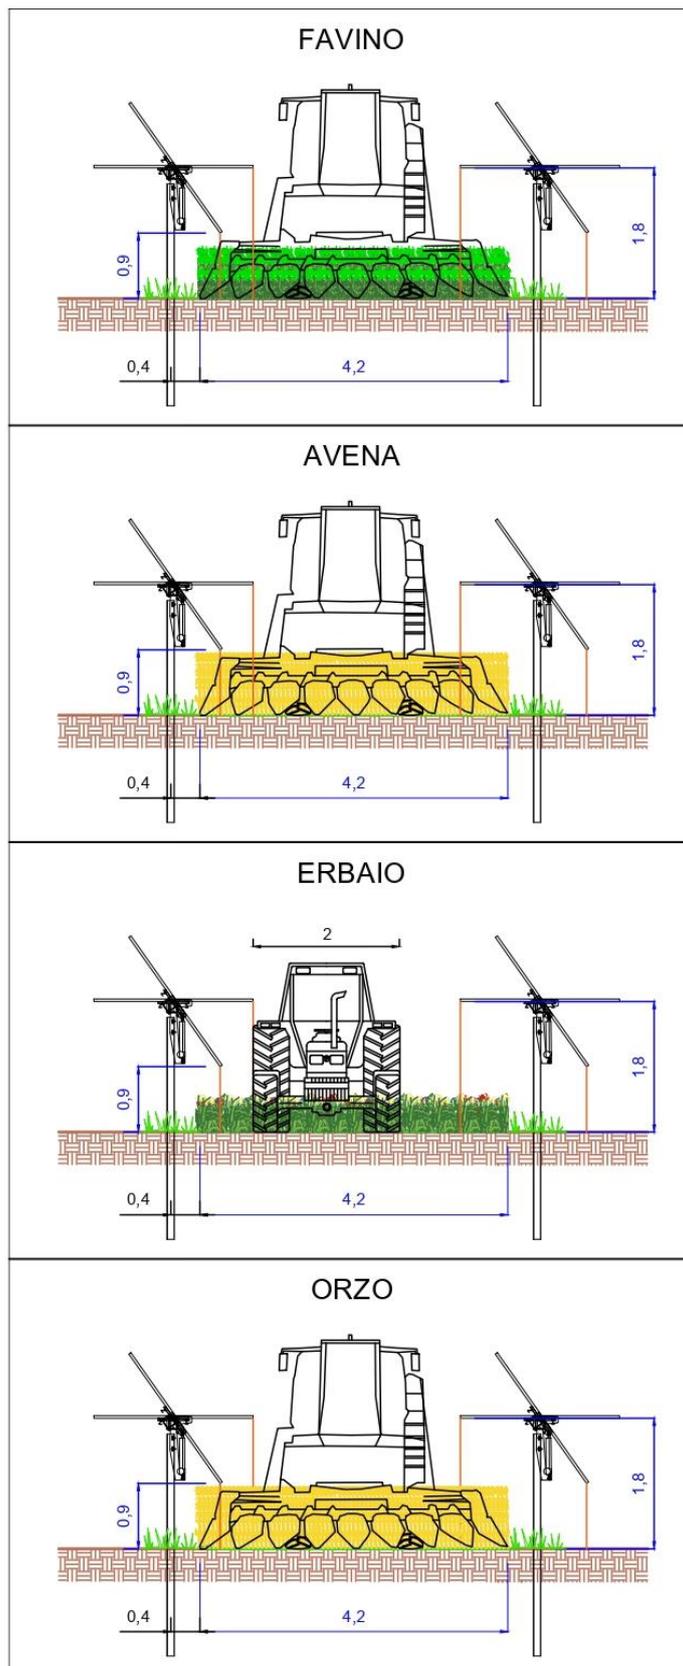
Rappresentazione del prospetto frontale delle colture favino, avena, orzo ed erbaio
